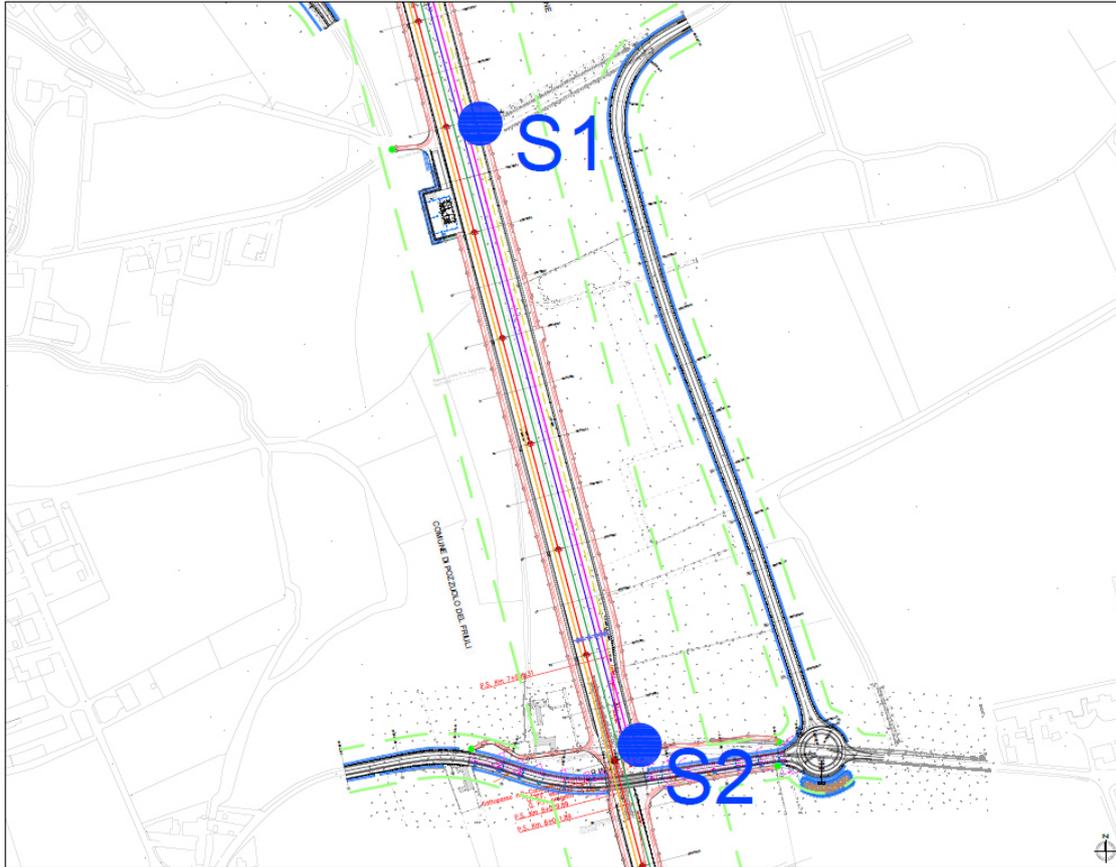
Ubicazione punti di campionamento rispetto alle opere in progetto
